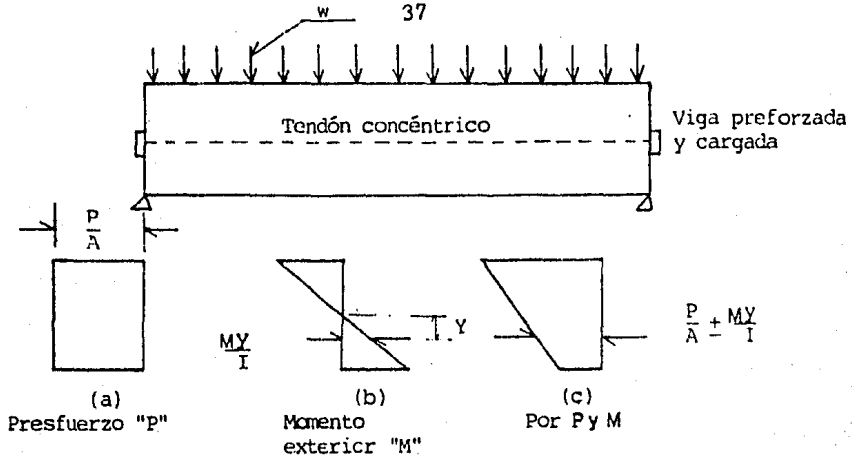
Distribución de esfuerzos a través de una sección de concreto presforzado concéntricamente.
